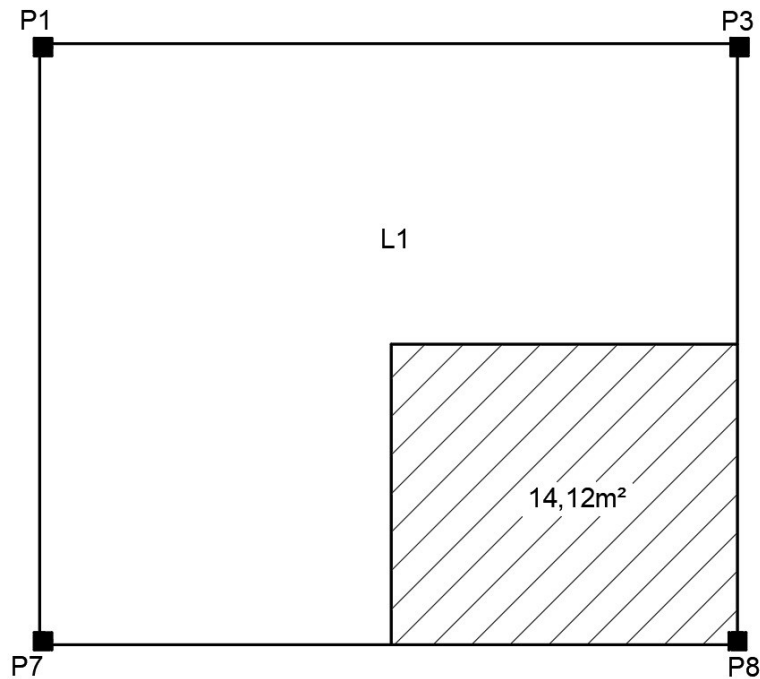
Área de influência do pilar P8 – teto do 3º pavimento
